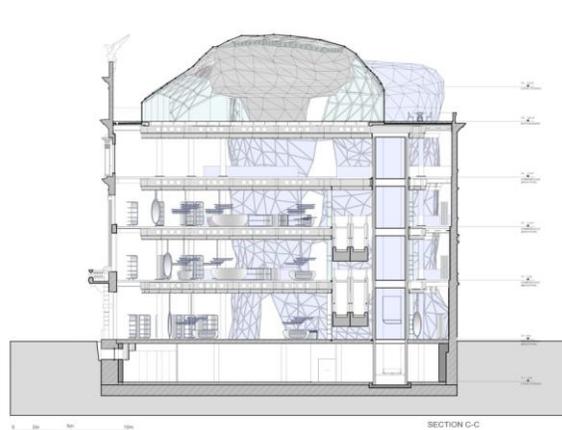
Vista del corte arquitectónico donde se aprecia la intervención interior.
